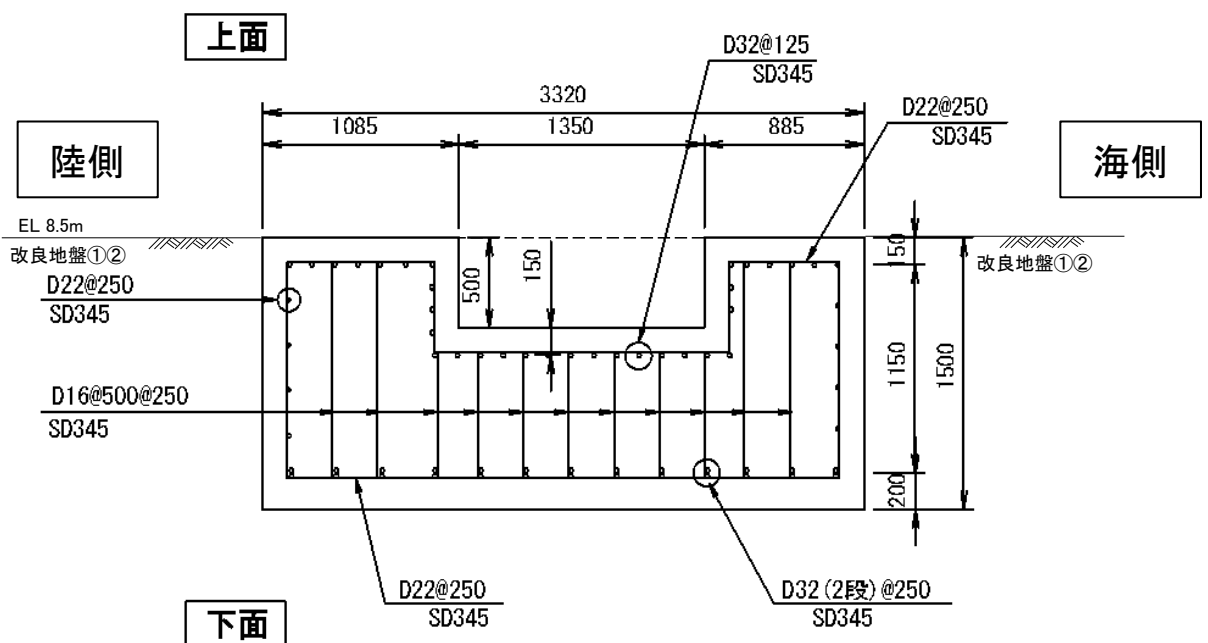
(2) 防波扉基礎スラブの概略配筋図 (B-B 断面)
